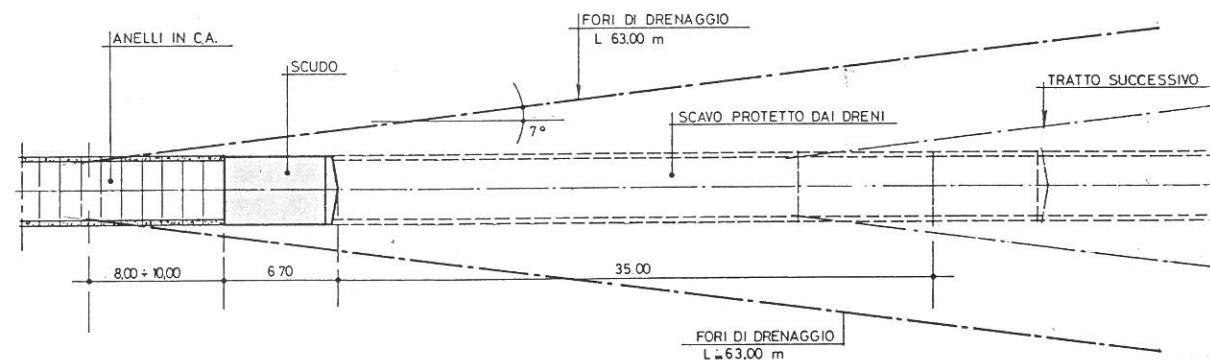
Lo schema dei tubi drenanti predisposti ad "ombrello" prima dell'avanzamento dello scudo per una tratta di 35 m di lunghezza
